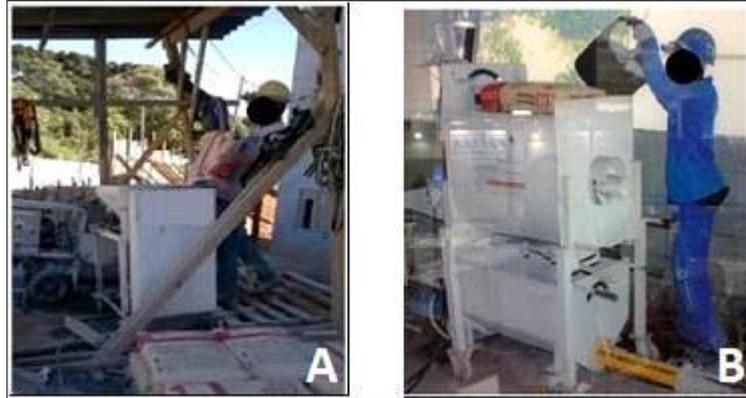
A) Detalhe da extensão da lombar ao carregar o misturador; B) Detalhe da elevação dos braços acima dos ombros
